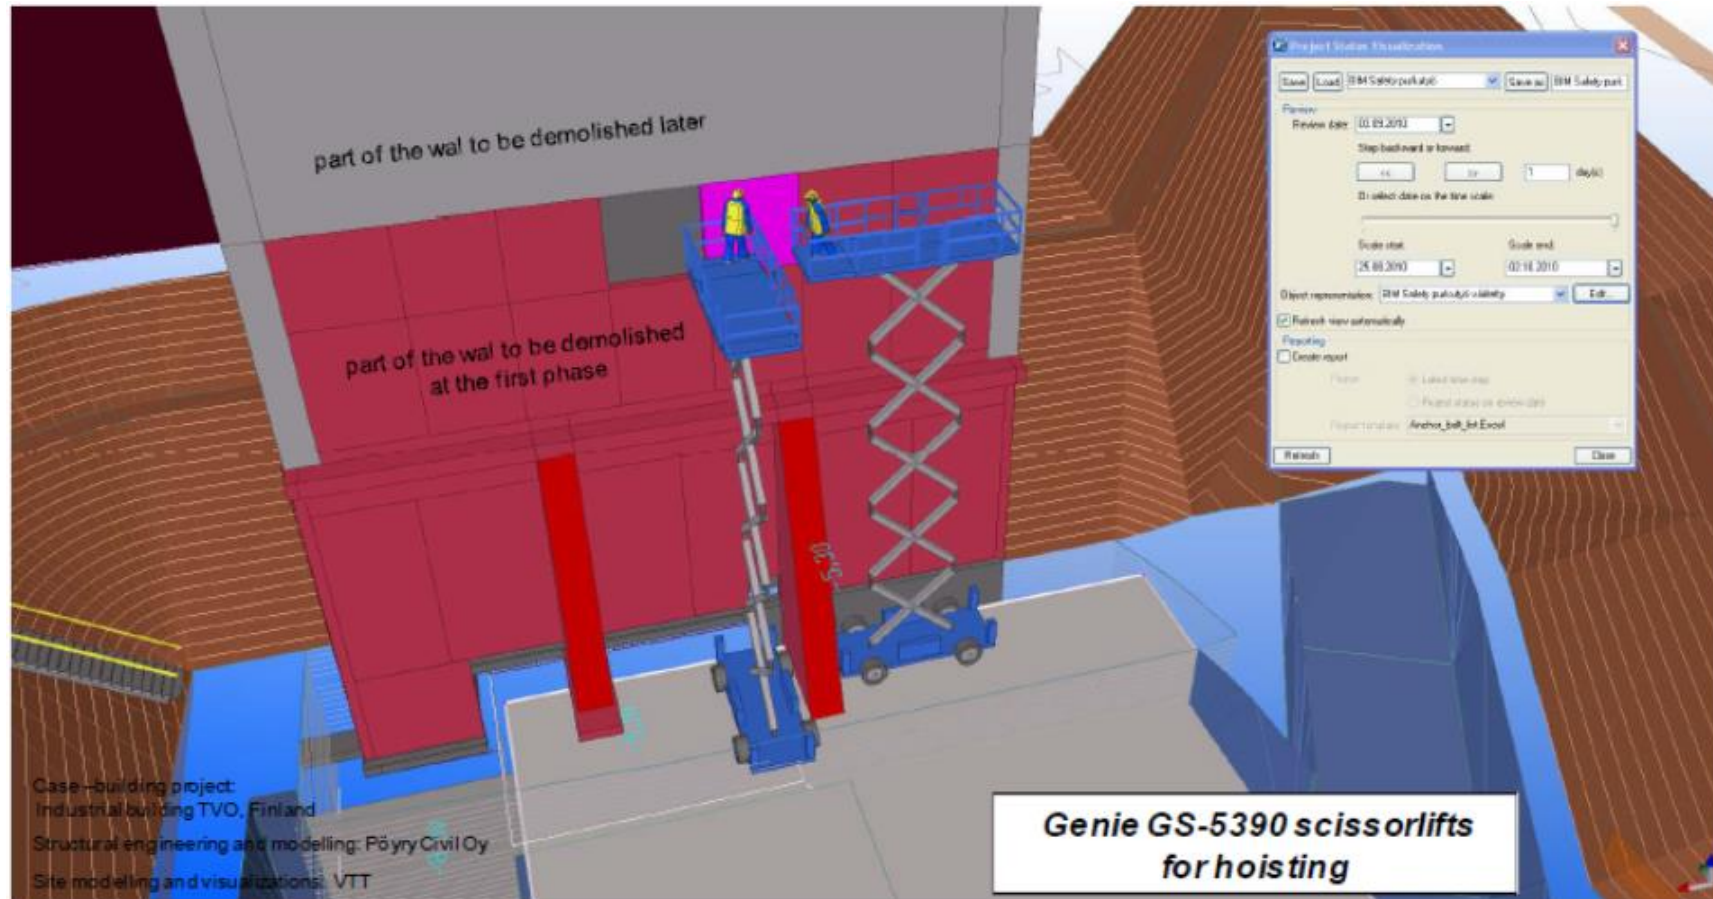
BIM 3D, fase di cantiere (da Kiviniemi M., Sulankivi K., Kahkonen K., Makela T., Merivirta M.L. 2011)
